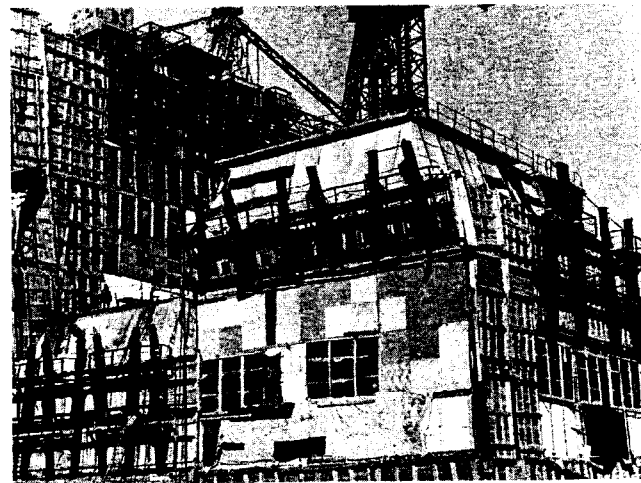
Укладка бетона на Саяно-Шушенской ГЭС зимой в самоподъемном тепляке и двухъярусной консольной опалубке
